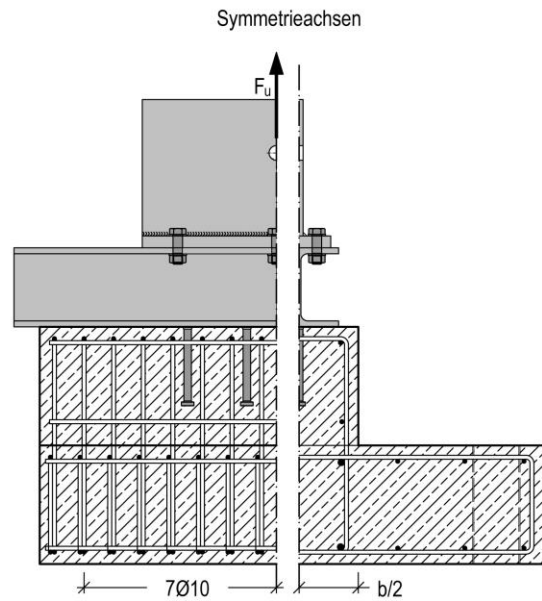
Schematischer Bewehrungsplan des Versuchskörpers R-06
